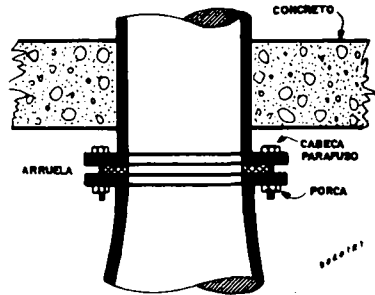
MONTAGEM ERRADA DOS FLANGES
